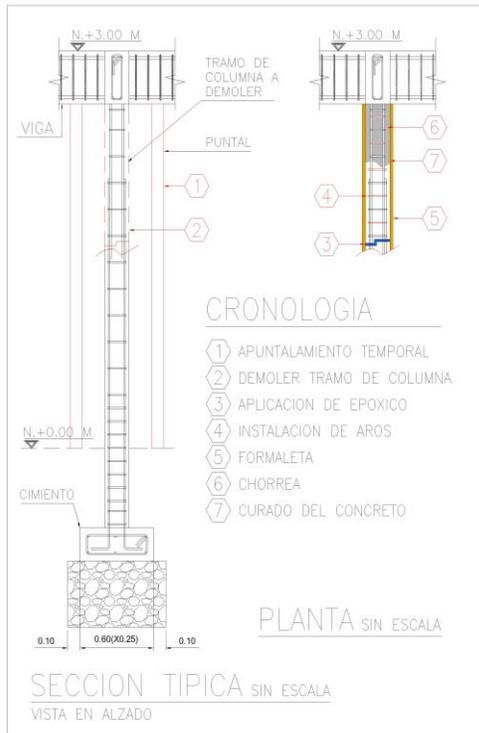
Vista en alzado de la columna con reparación zonificada. Autocad 2005.
